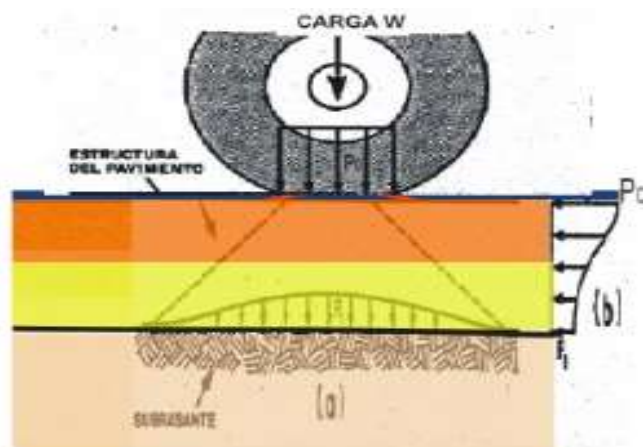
Distribución de cargas a través de un pavimento flexible.
